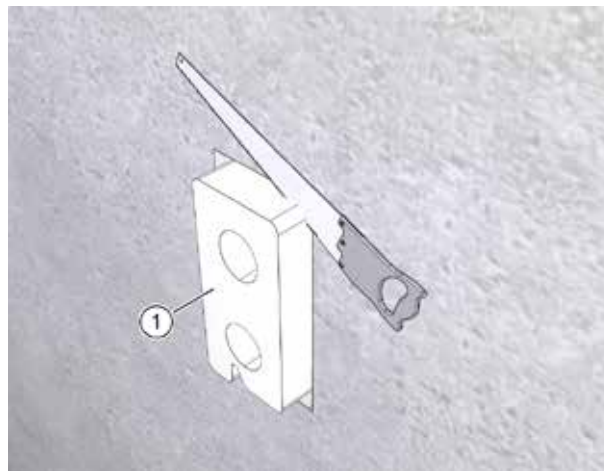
Modifica della cassetta a muro senza elemento di riempimento
